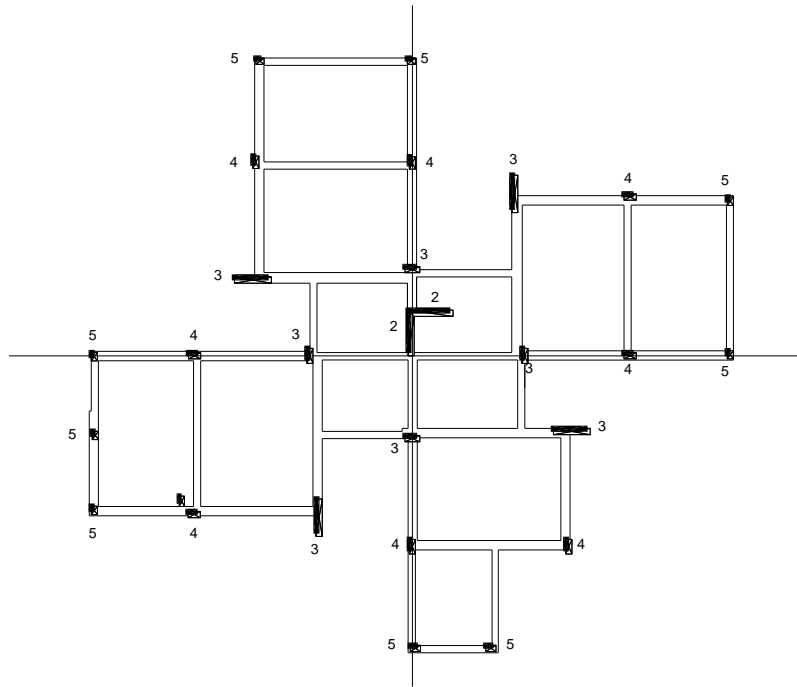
Tiempos de retardo de las columnas para el nivel 3.
